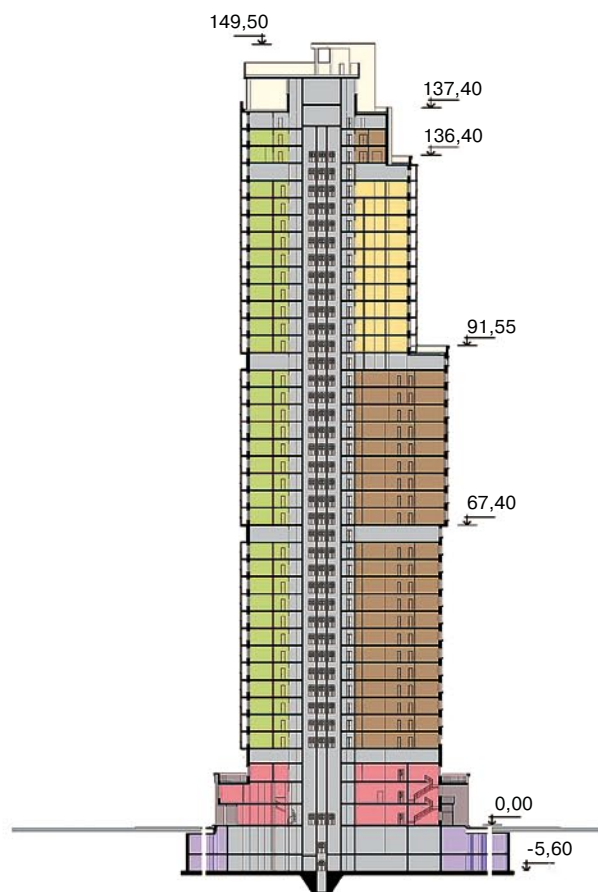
Цветовое решение фасадов и разрез высотного жилого дома по ул. Дыбенко в Москве
